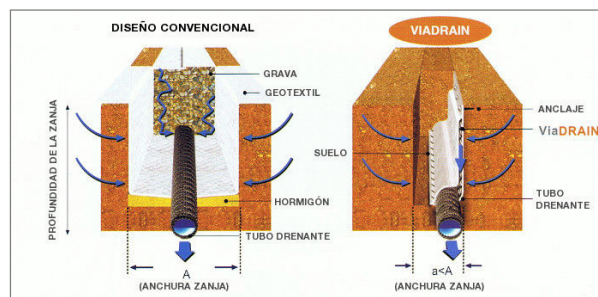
Subdrenajes Longitudinales Prefabricados.
